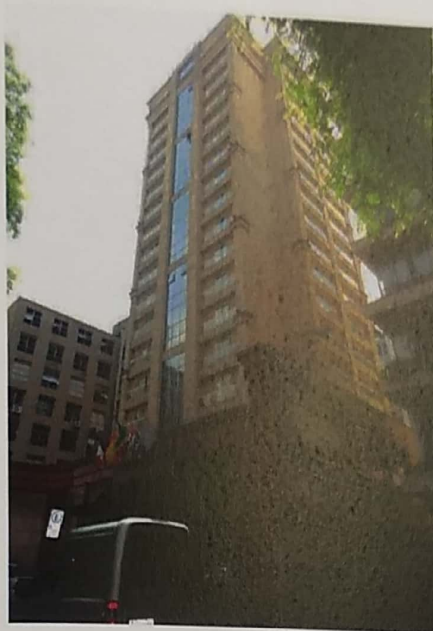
Vista da fachada do Cond. Edifício Paulista Internacional, localizado na Rua Haddock Lobo, nº 294.
